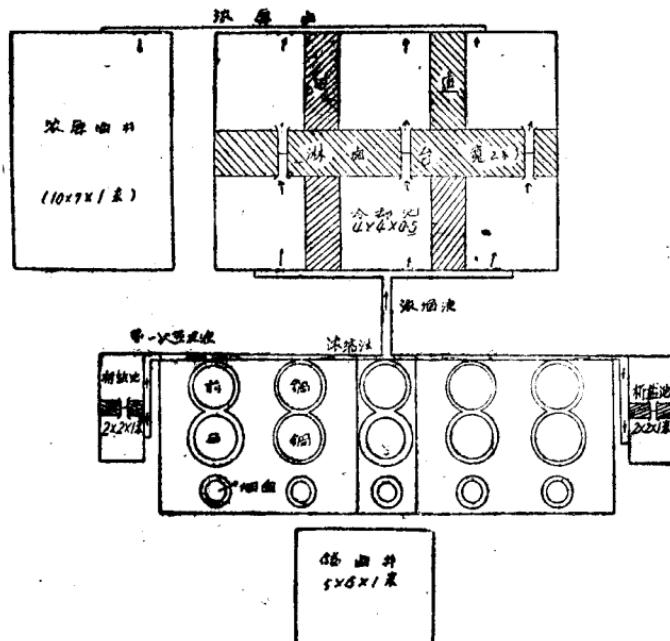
鋰鹽肥生產基本單元平面布置圖之一（按不允鹵分段法布置）
